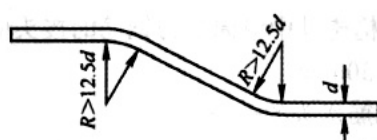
F416022-8 弯起钢筋弯折处圆弧内半径示意图
